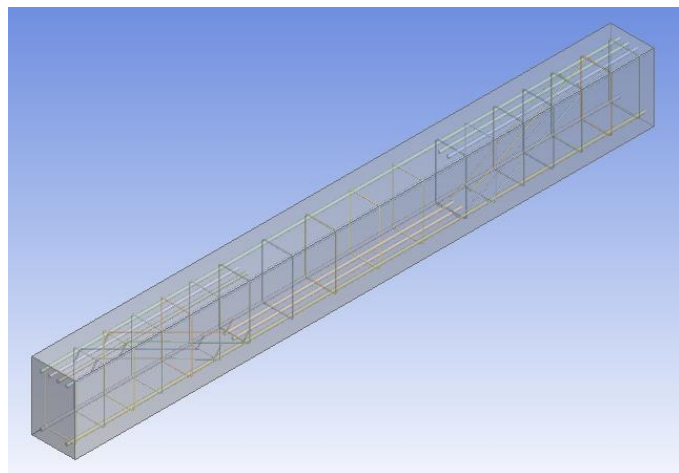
Pemodelan balok tulangan sengkang 45 derajat
